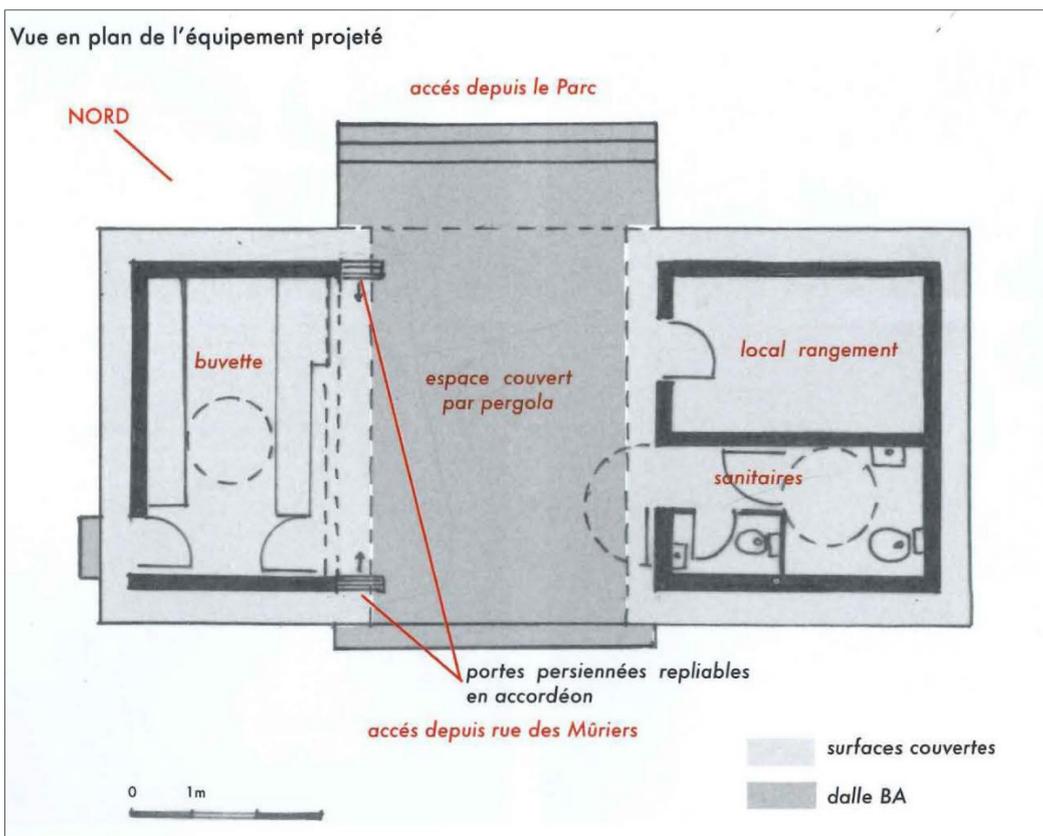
vue en plan et projection sur photo aérienne de la construction projetée
